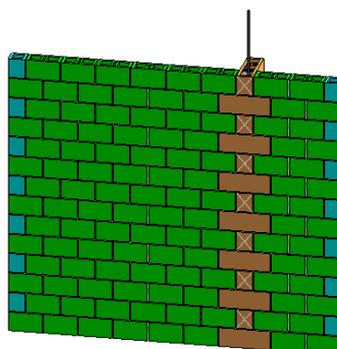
79 – Representação da armadura em vistas de elevações laterais.
